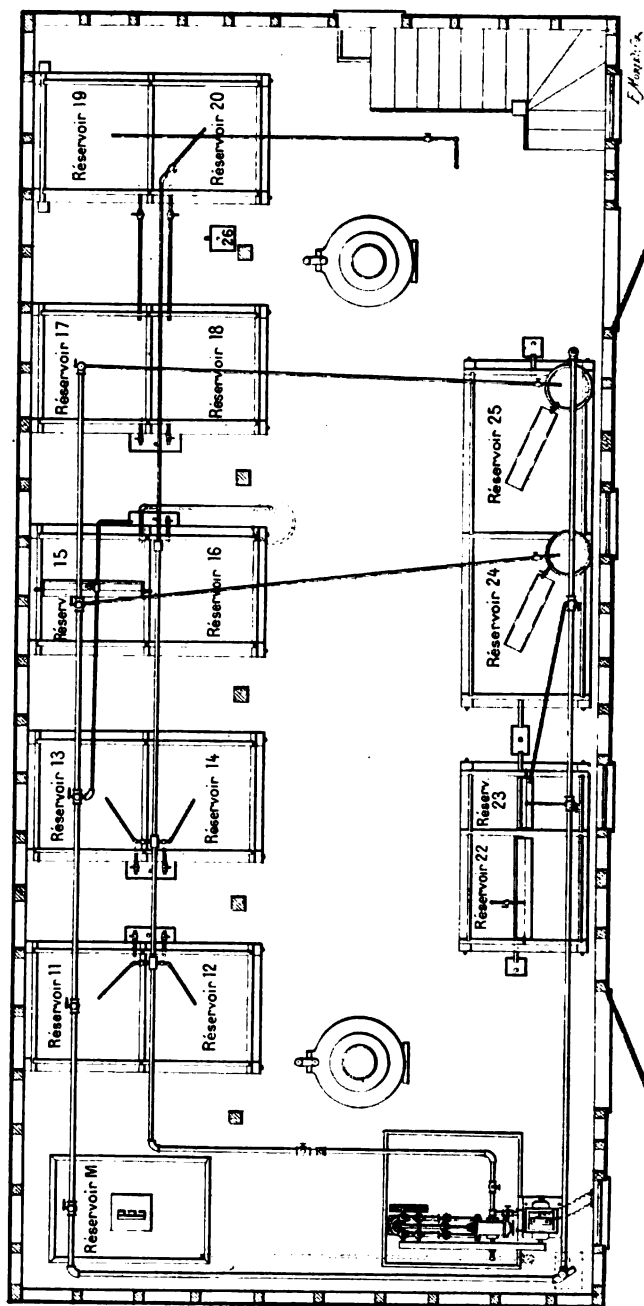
Plan du rez-de-chaussée de la station expérimentale de Boston (Massachusetts).
